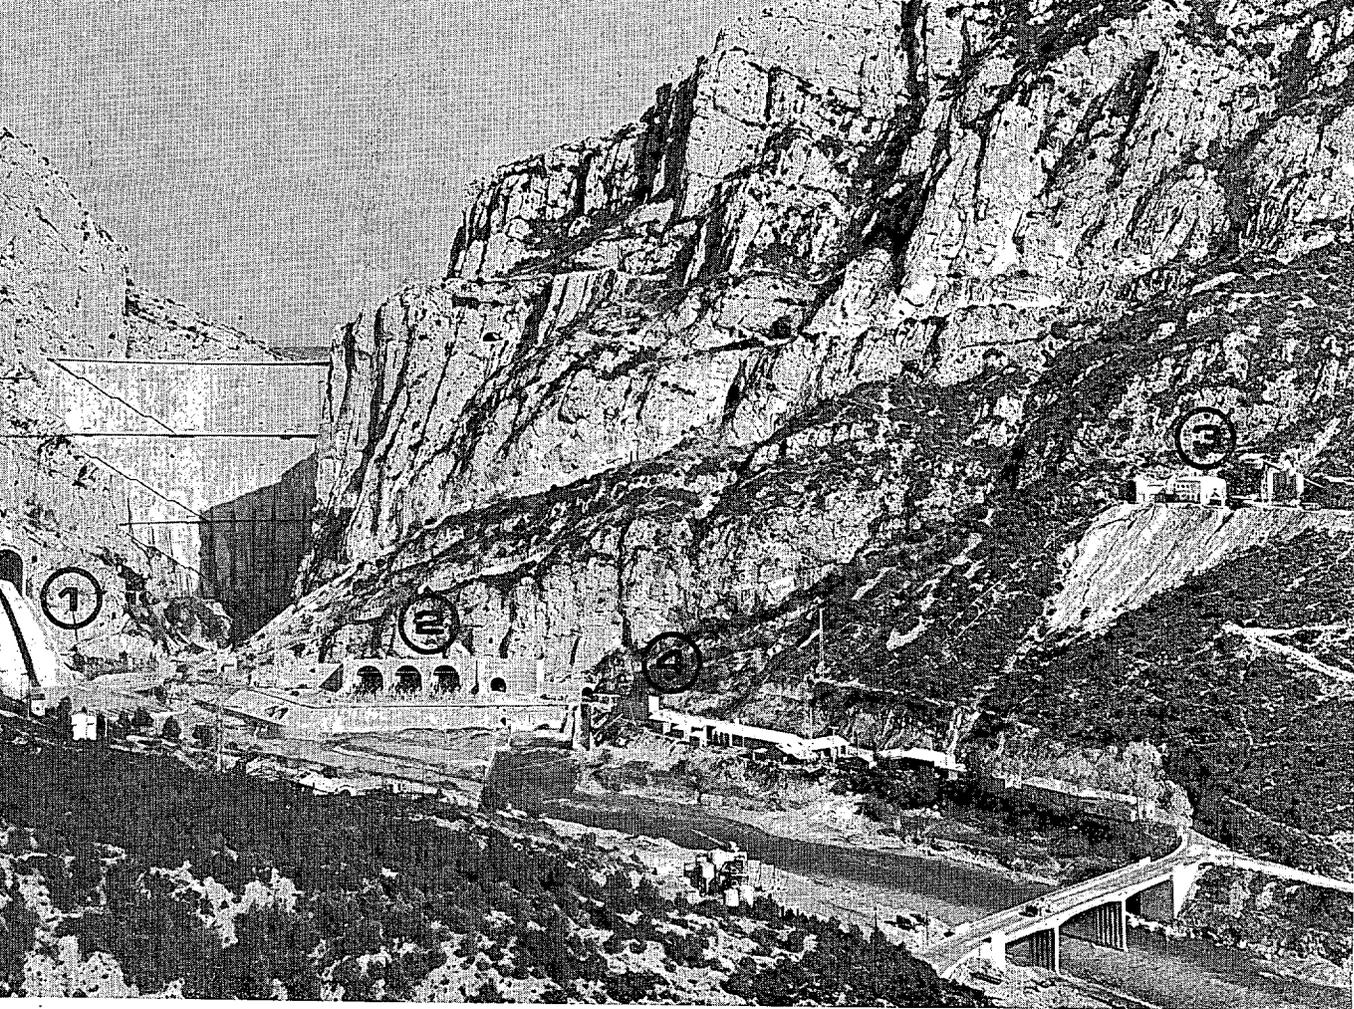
Vista general de presa y estribo izquierdo: 1, aliviadero; 2, parque; 3, entrada a la galería 450 y central de inyección; 4, entrada a la galería 380.
